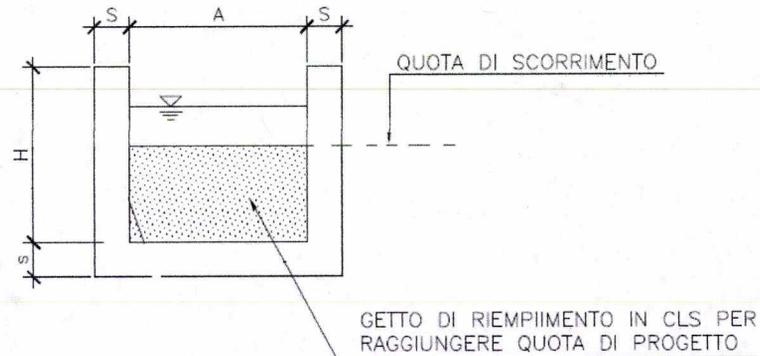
Dettaglio canaletta rettangolare con getto di riempimento
